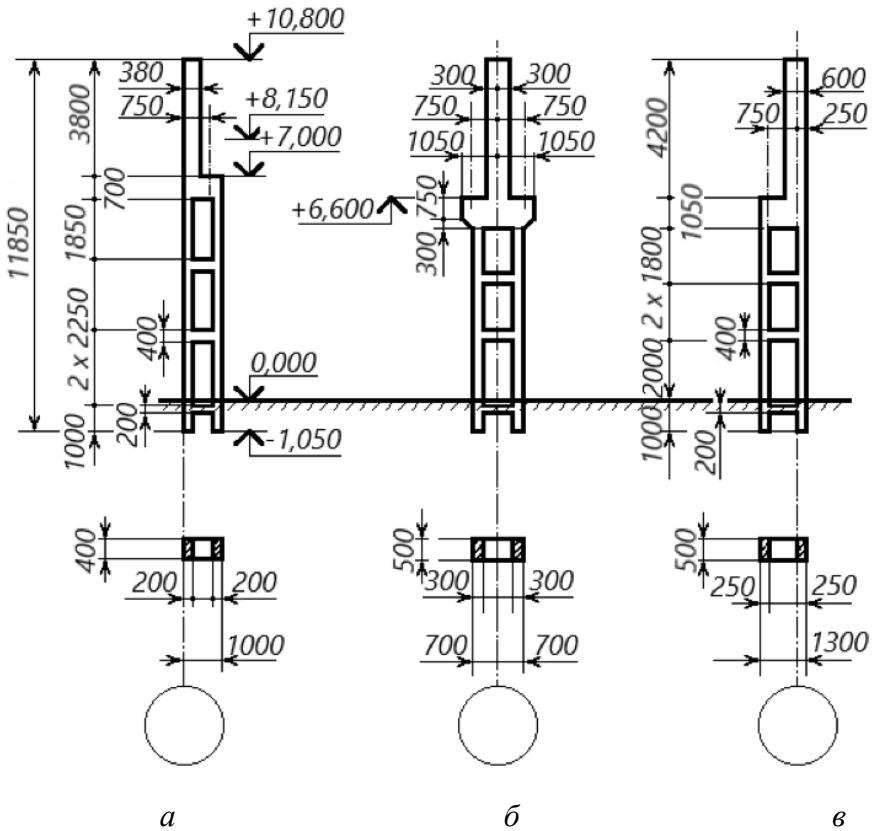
Типові двовіткові колони для будівель висотою 10,8 м з кранами вантажністю 100 кН або 200/50 кН, прольотами 18 м або 24 м; *a* – крайня колона з кроком 6 м, *б* – середня колона з кроком 12 м, *в* – крайня колона з кроком 12 м
